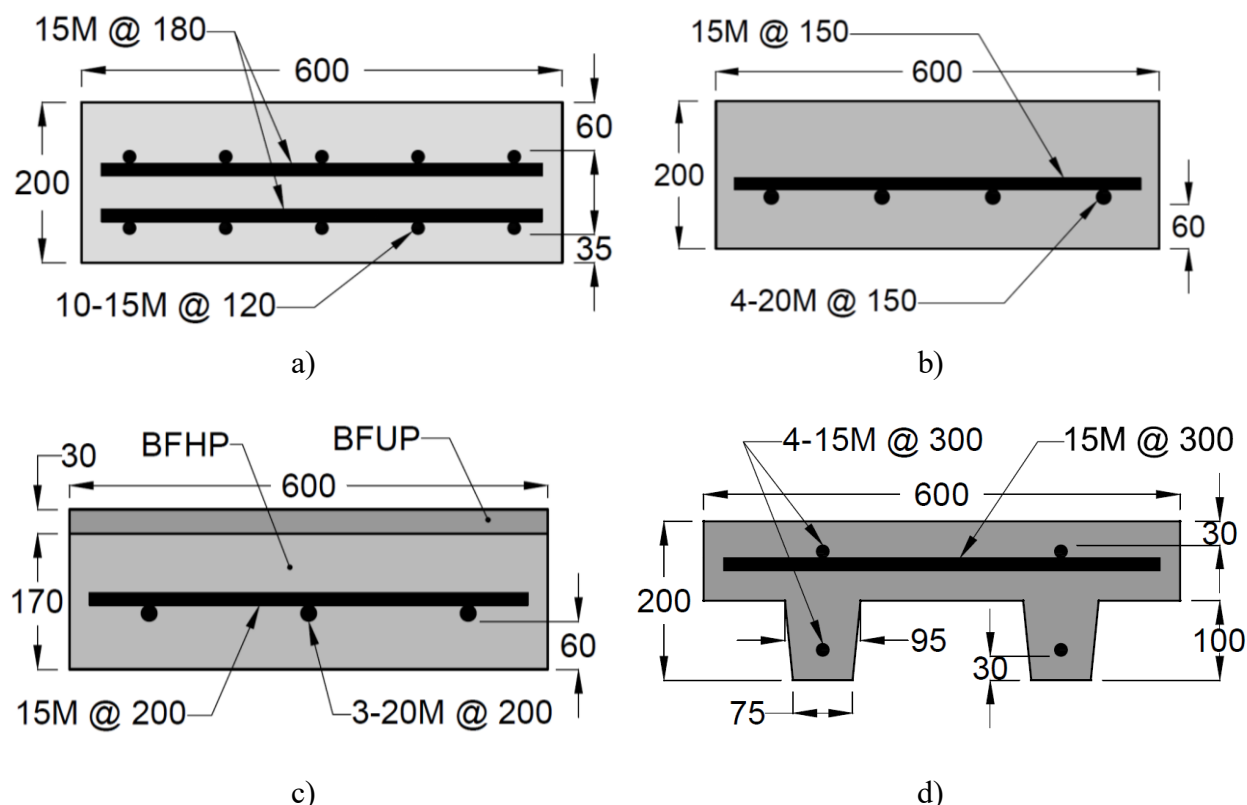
Section des spécimens de dalles : a) BHP, b) BFHP, c) Hybride, d) BFUP
